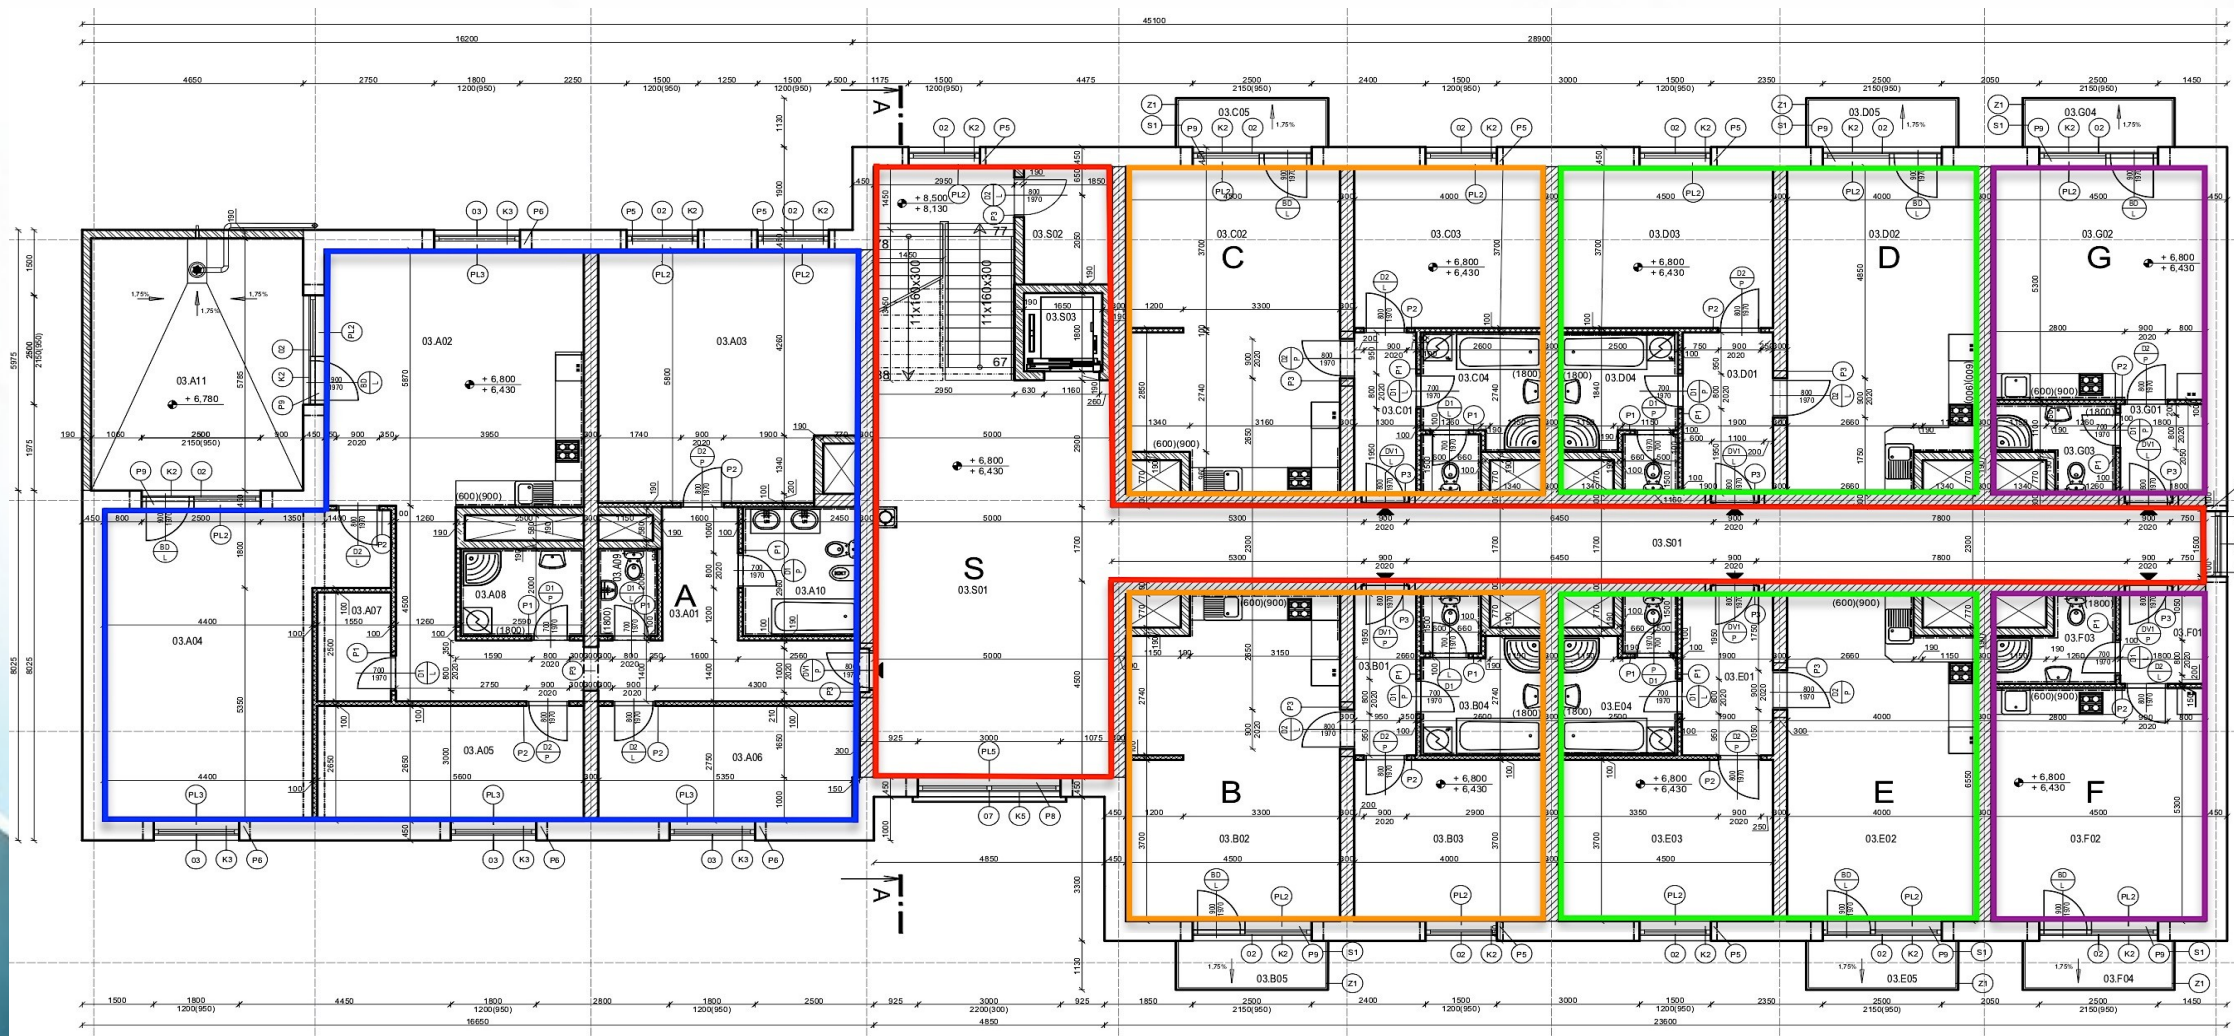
Půdorys 1.NP, zdroj: vlastní
